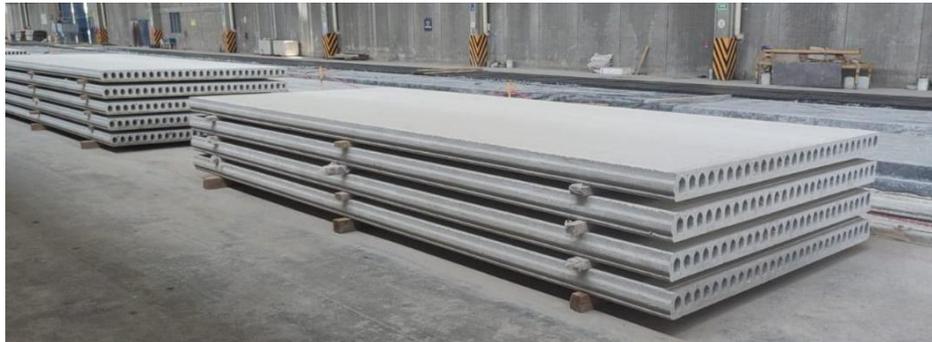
Estibado y almacenaje de elementos prefabricados.
